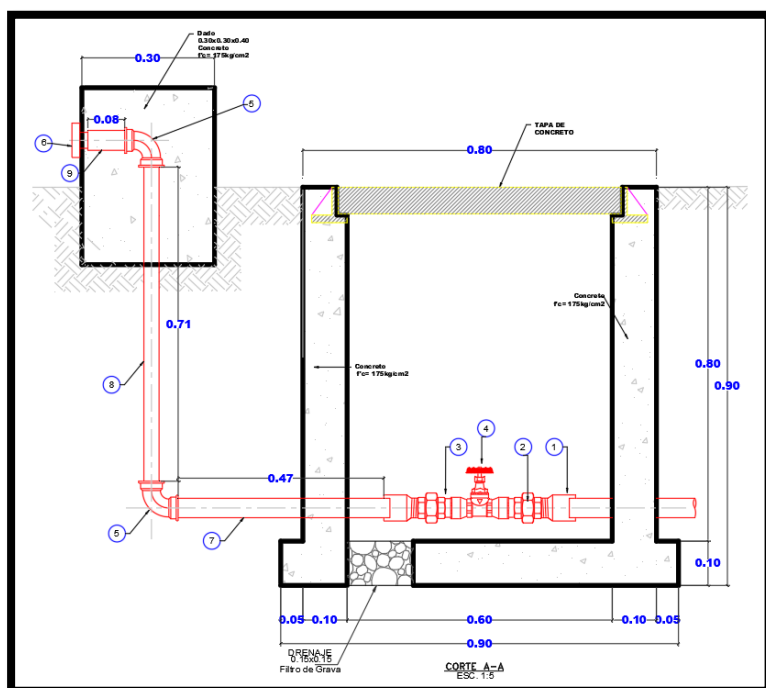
Diseño en Planta de Válvula de Purga T-2
